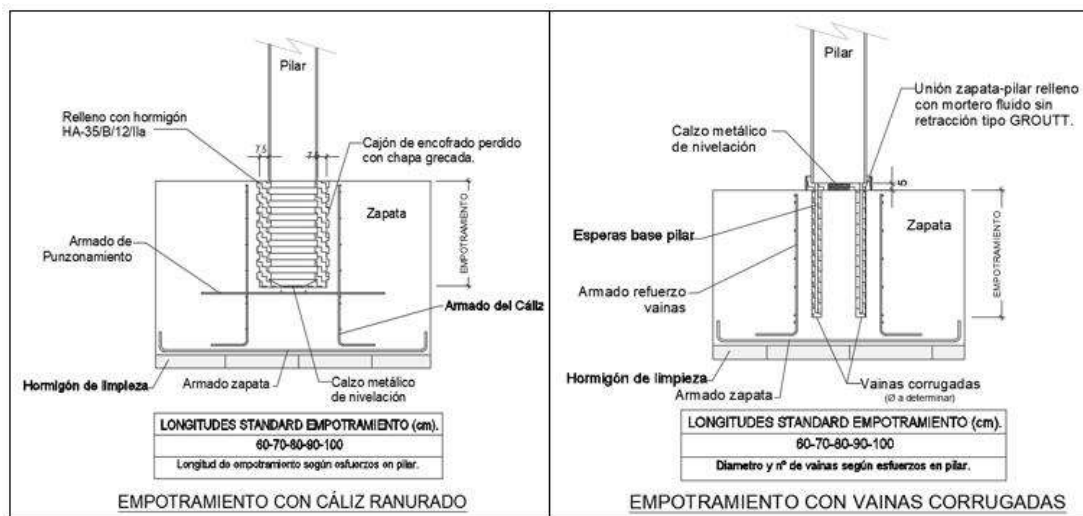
Detalle de empotramiento con cáliz ranurado y con vainas corrugadas.
